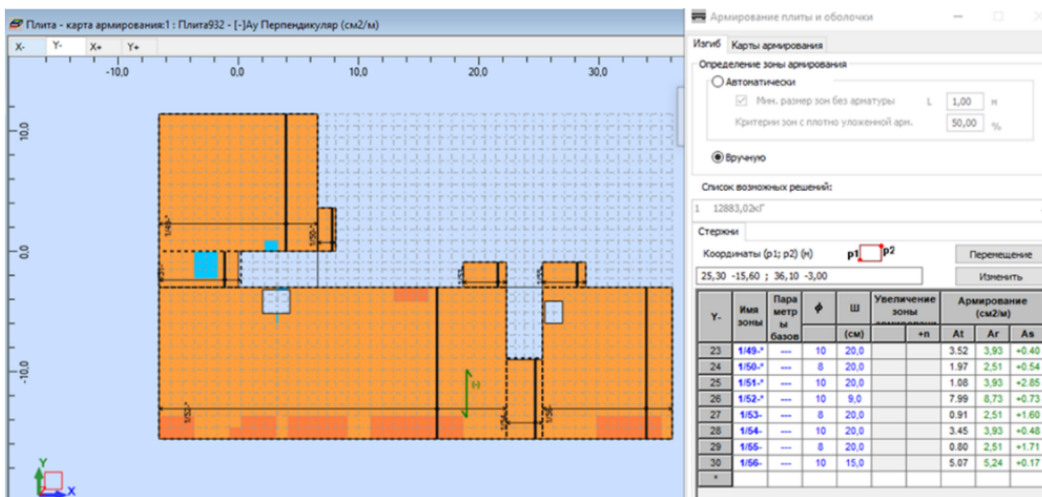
Нижнее армирование плиты по оси Y в ПК RSA
